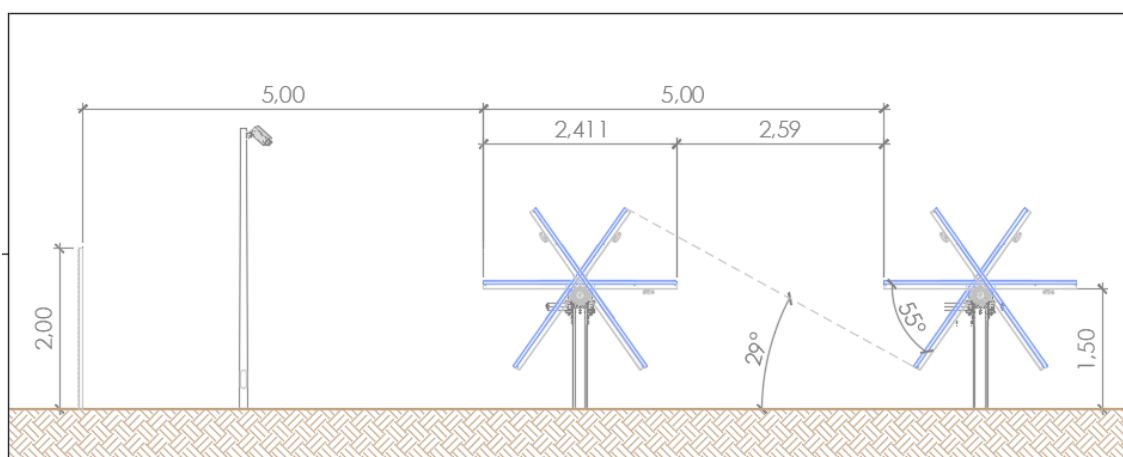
Particolare esemplificativo di una sezione trasversale di impianto.
